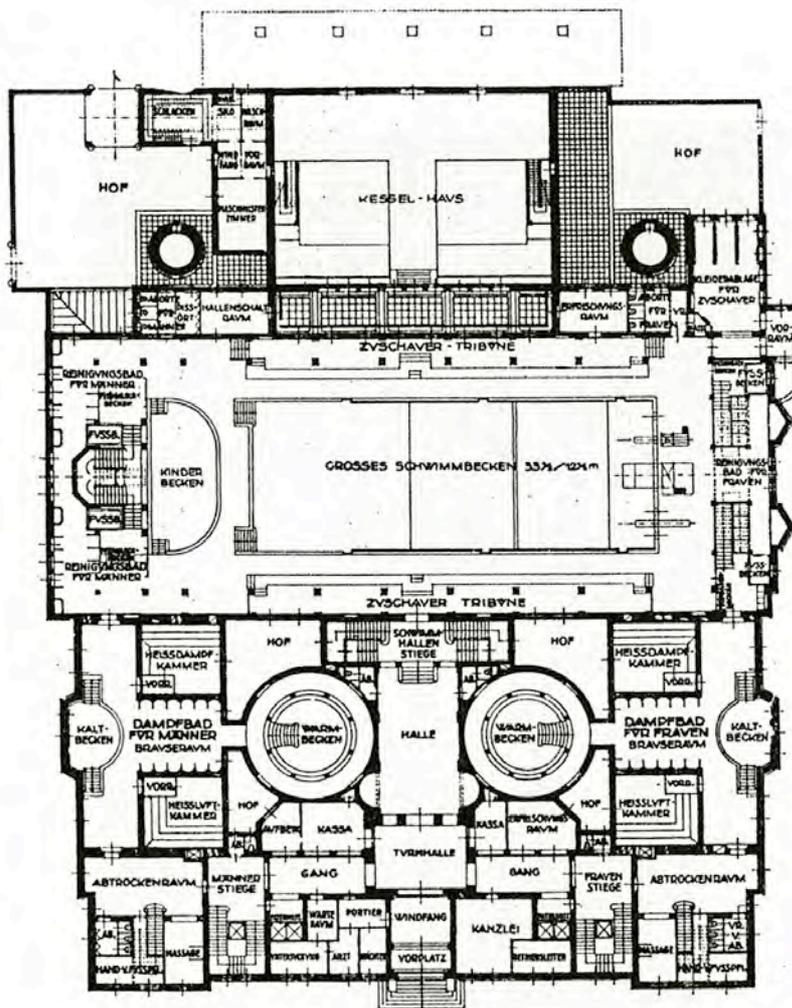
Grundriss Erdgeschoss des Amalienbads in Wien, 1926 (aus: Ilse Hess, Die Neuorientierung im Bäderbau 1870 bis 1985, Hamburg 1983, S. 256, Abb. 44)
